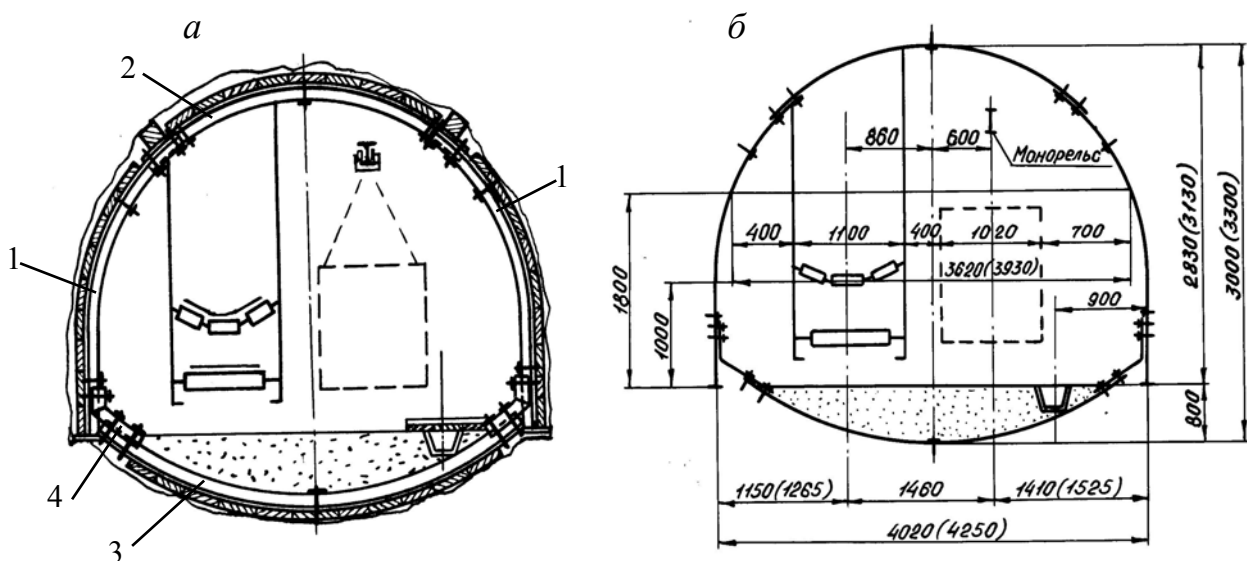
Схеми кріплення замкнутої конструкції АЖЗ
